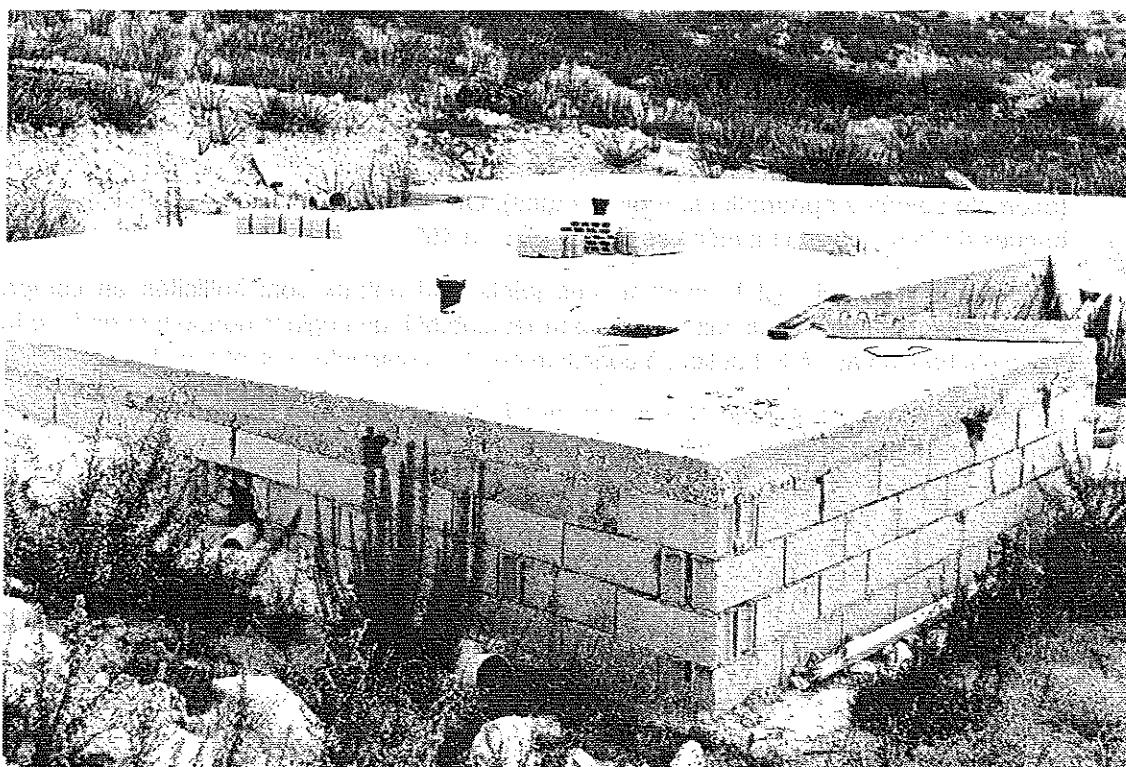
Exemple de montage de maçonnerie de blocs béton à joints non horizontaux. © J. Putatti
